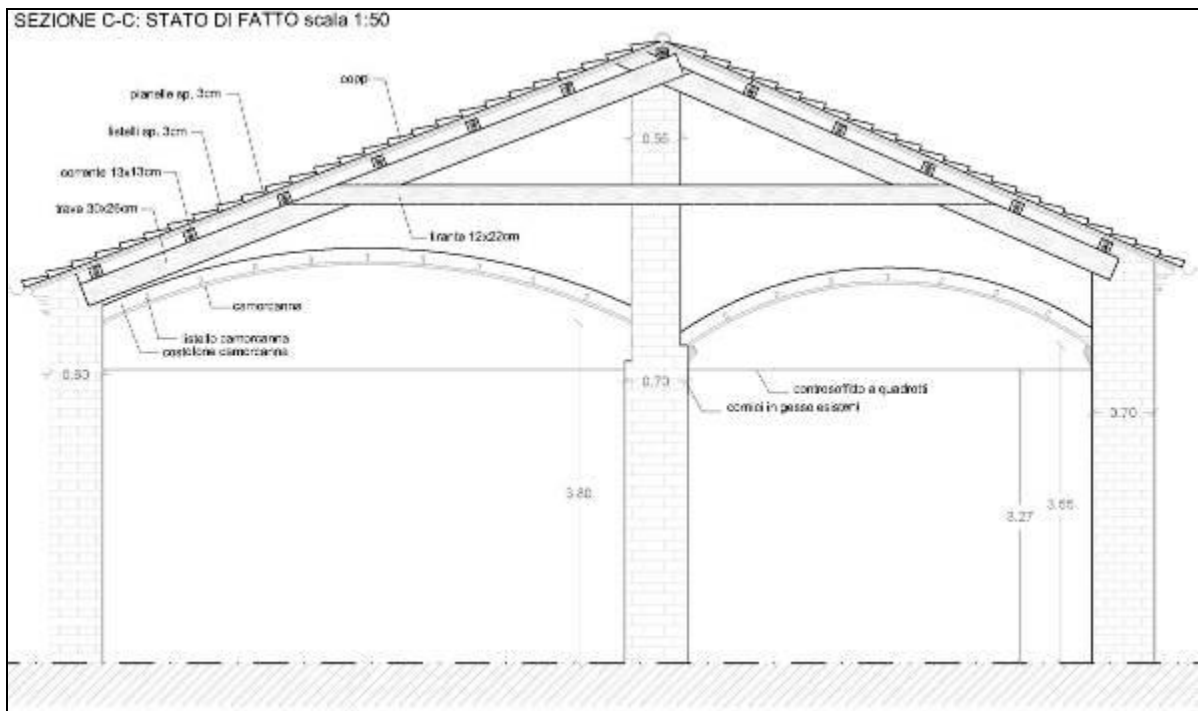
Sezione trasversale del tetto allo stato attuale
